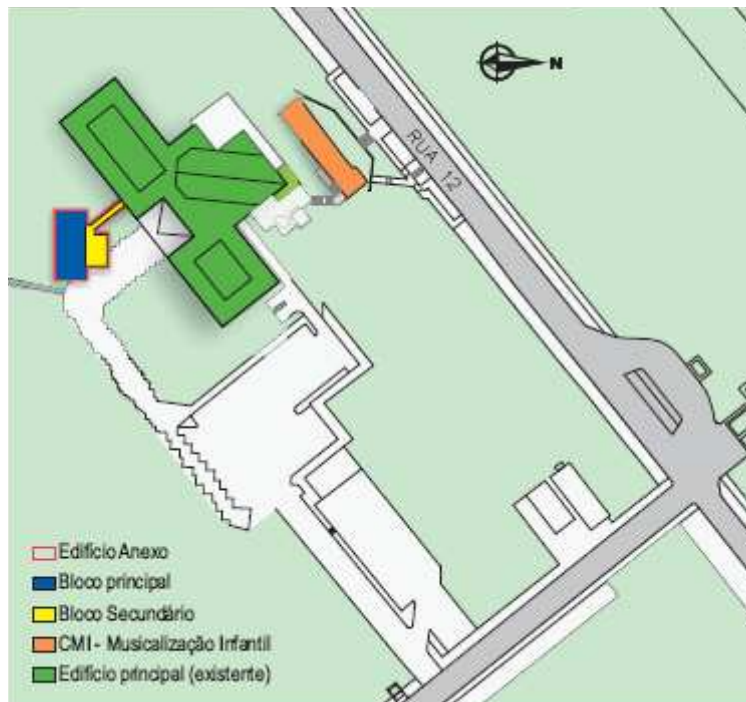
Planta de situação dos edifícios principal (existente) e anexo (em projeto), em relação ao arruamento existente.
